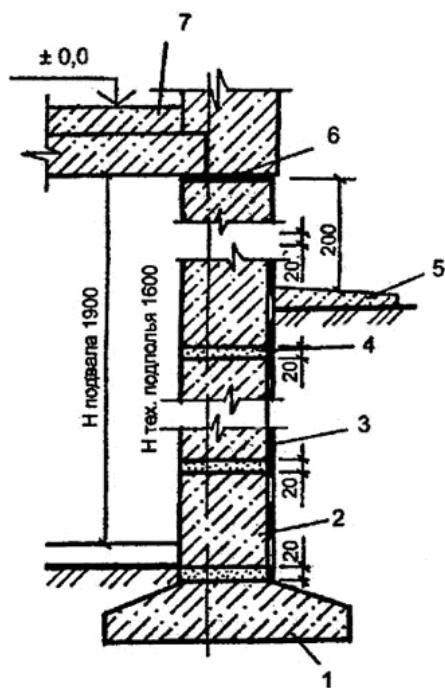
Сечение сборного ленточного фундамента из бетонных блоков под стены дома с подвалом и техническим подпольем: 1 – фундаментная плита; 2 – бетонные стеновые блоки; 3 – окраска горячим битумом; 4 – цементно-песчаный раствор; 5 – отмостка; 6 – два слоя толя или гидронзола на битумной мастике; 7 – цокольное перекрытие
